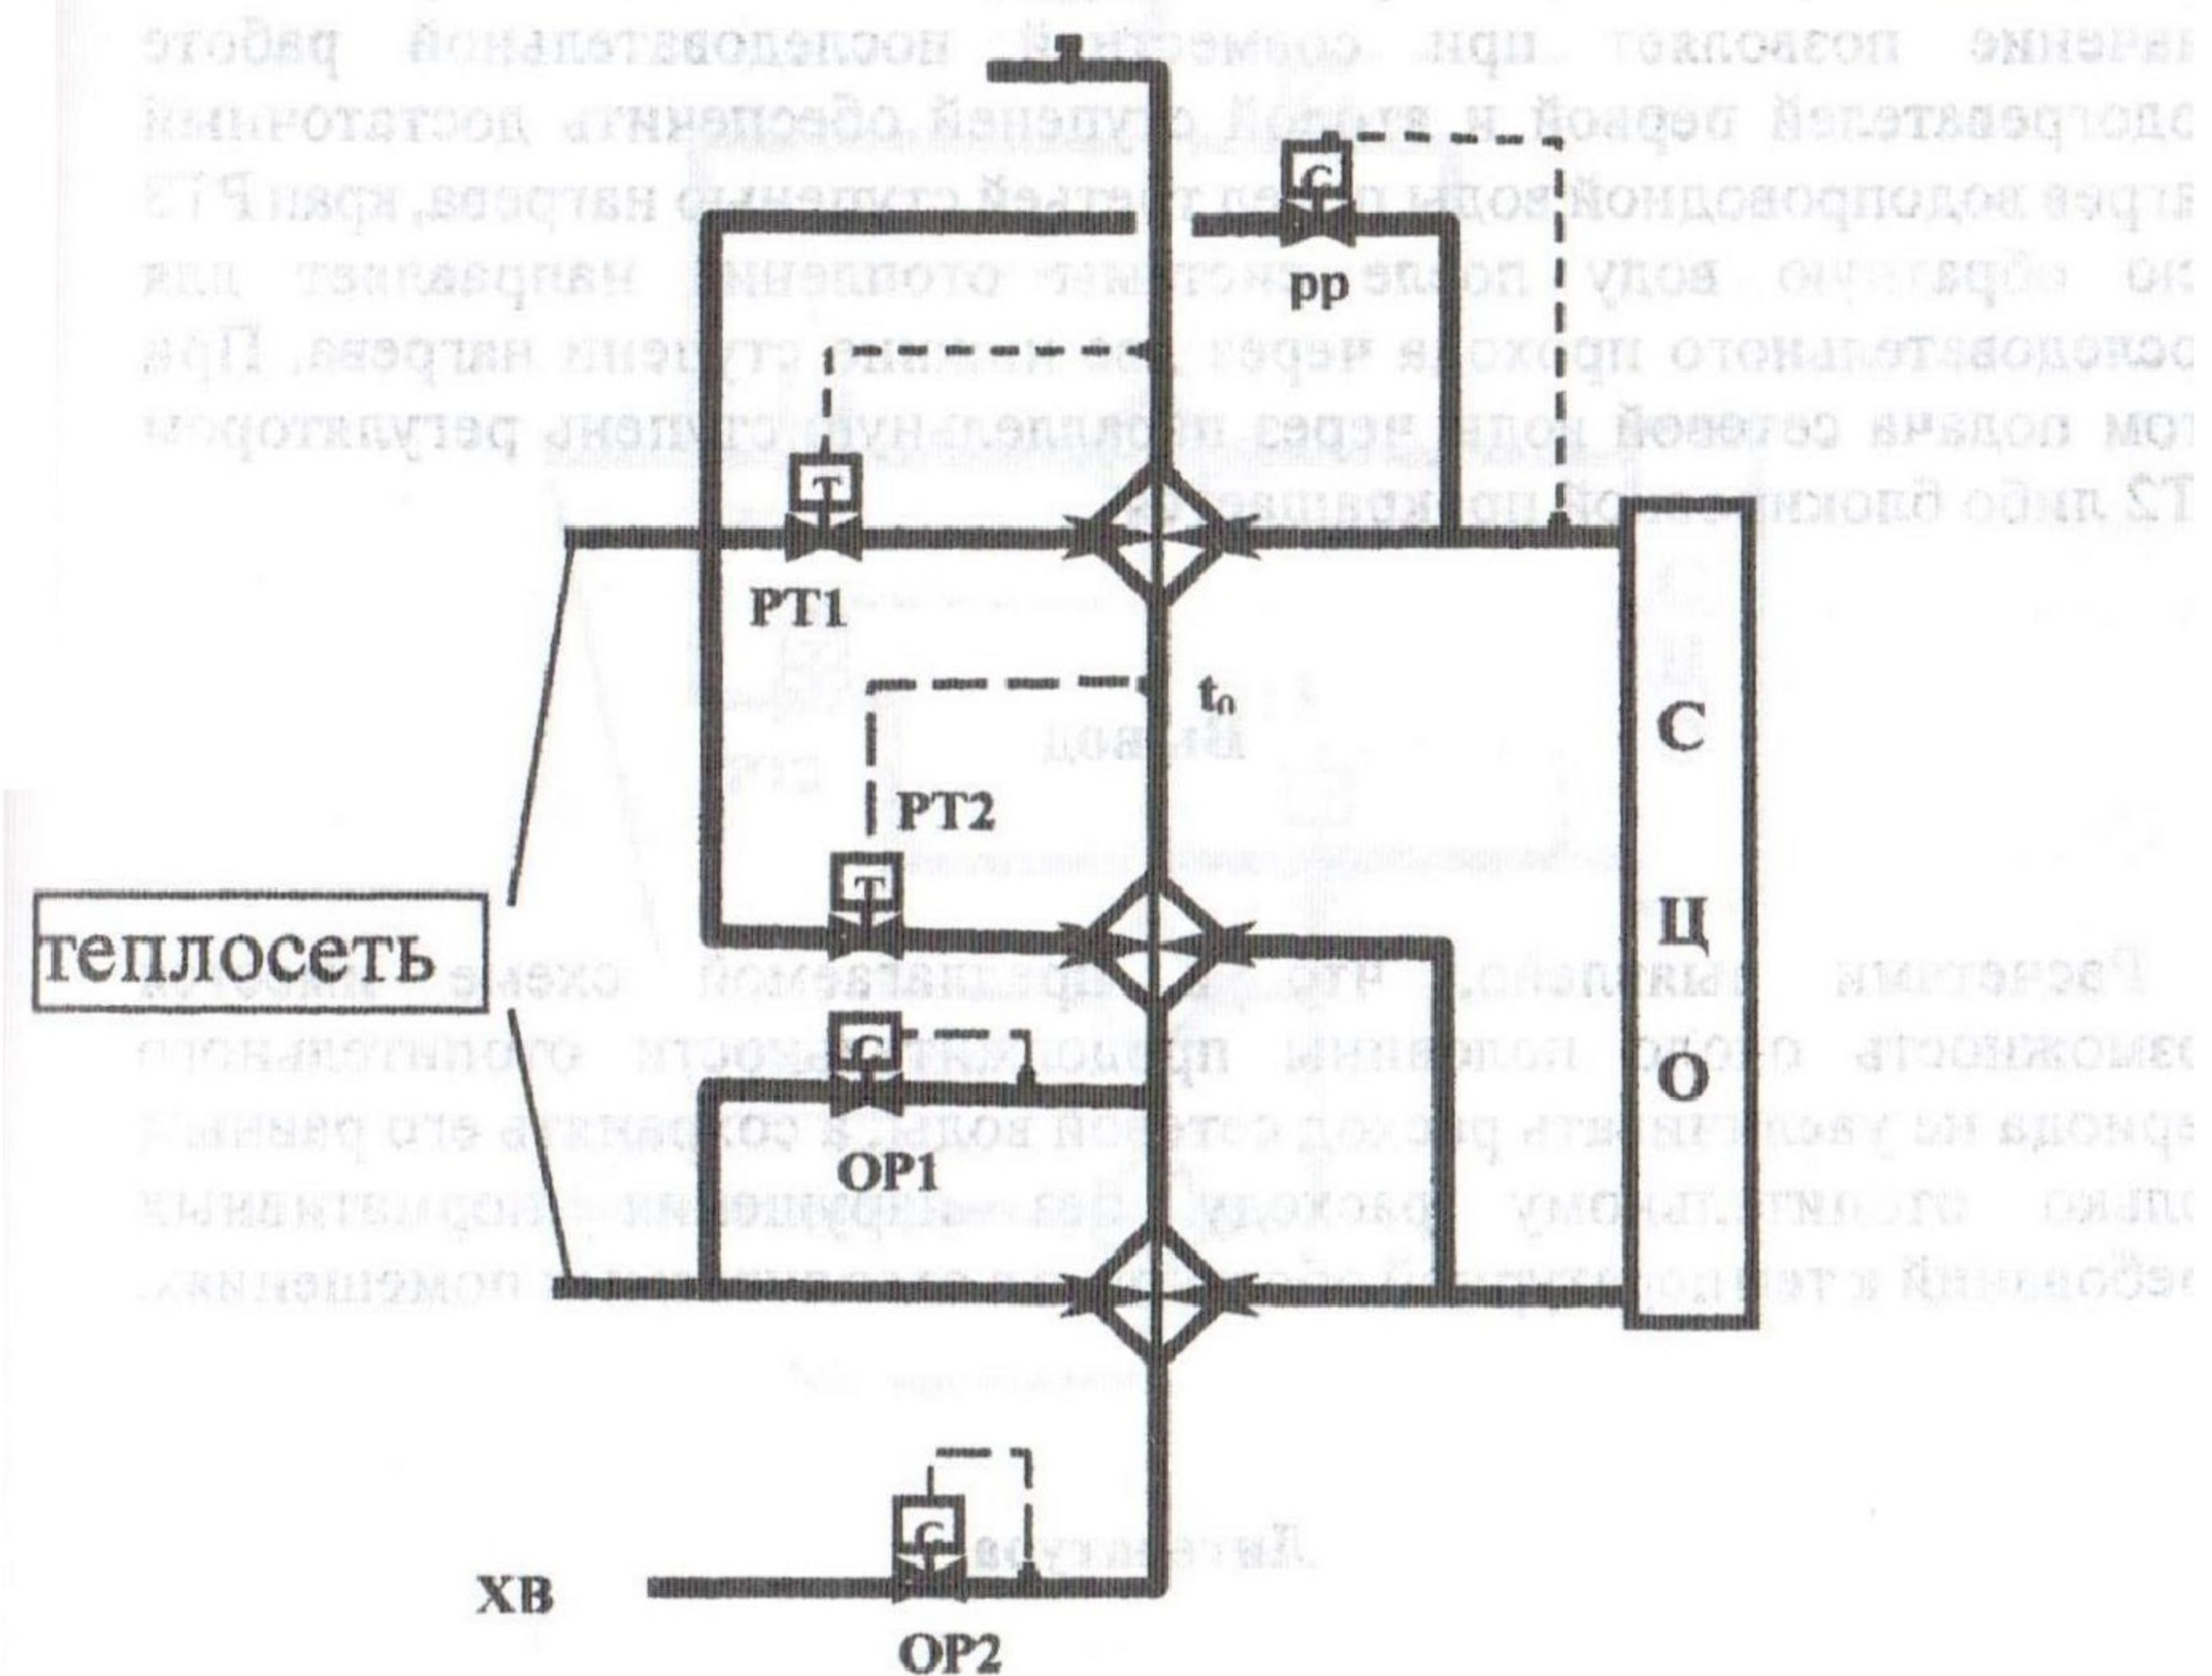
Схема универсальной полузамкнутой системы теплоснабжения
